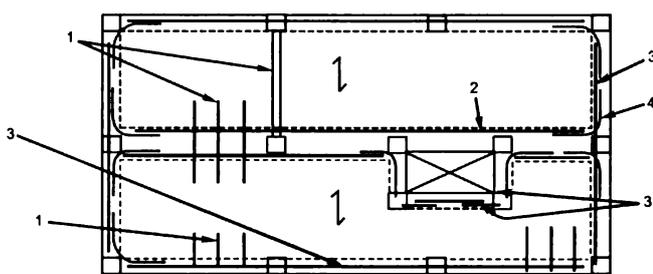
Общая принципиальная схема размещения внутренних продольных (1), поперечных (2), периметрических (3) и угловых (4) связей
